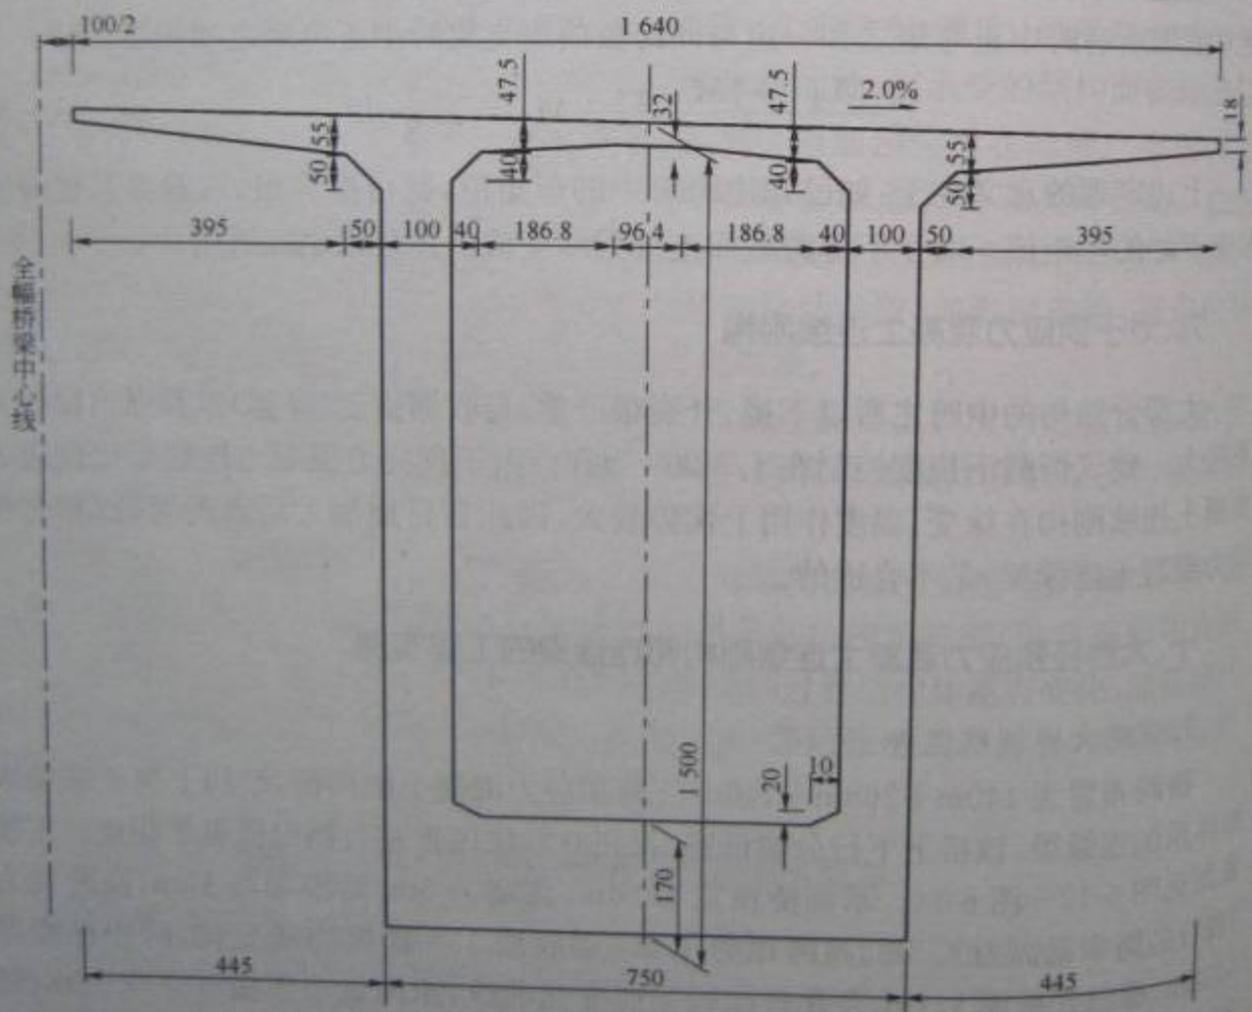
苏通大桥辅桥主桥 0 号块截面(尺寸单位:cm)
